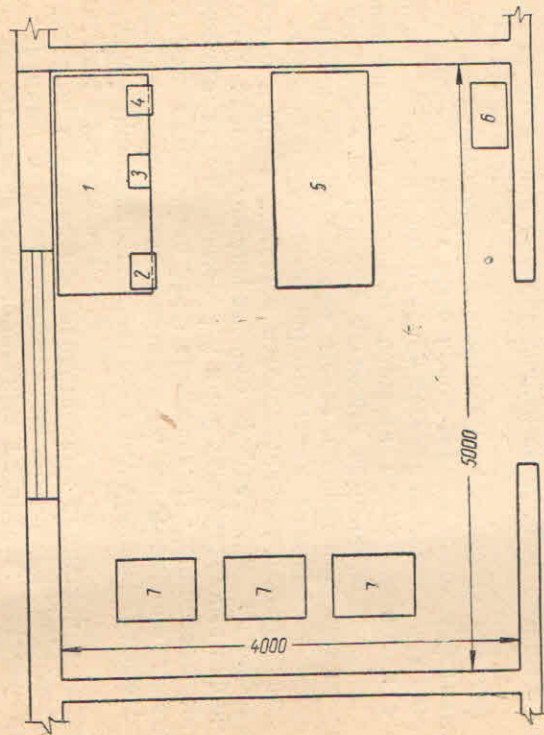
План участка для изготовления автомобильных резиновых деталей:
